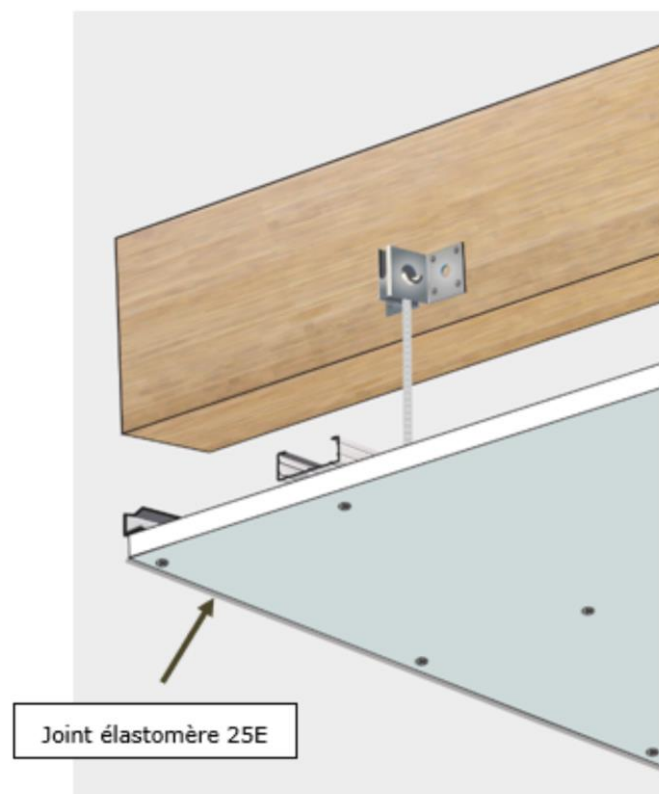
Dispositif de suspension sous charpente bois-Détail raccordement plafond – mur avec joint élastomère
